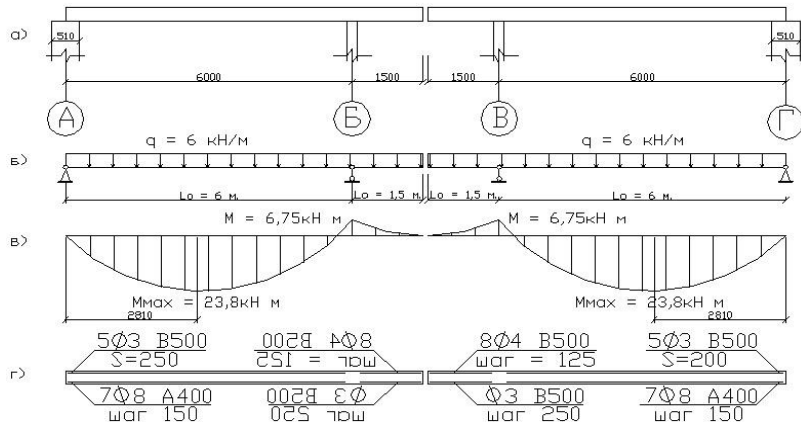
Конструктивная (а), расчетная (б) схемы, эпюры моментов (в), схемы армирования (г) для перекрытия. Вариант 2.
